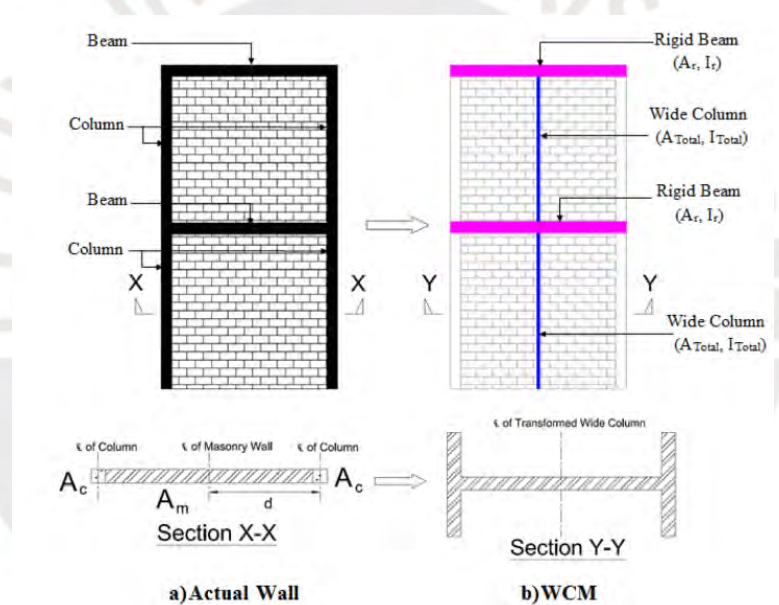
Ejemplo del Modelo de Columna Ancha y Sección Transformada
